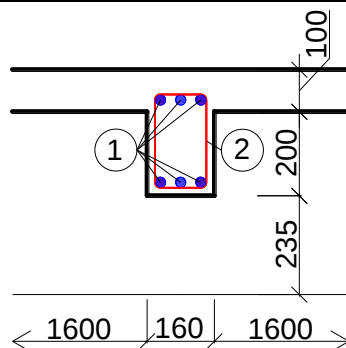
Detail sekané sondy u spodního líce průvlaku
